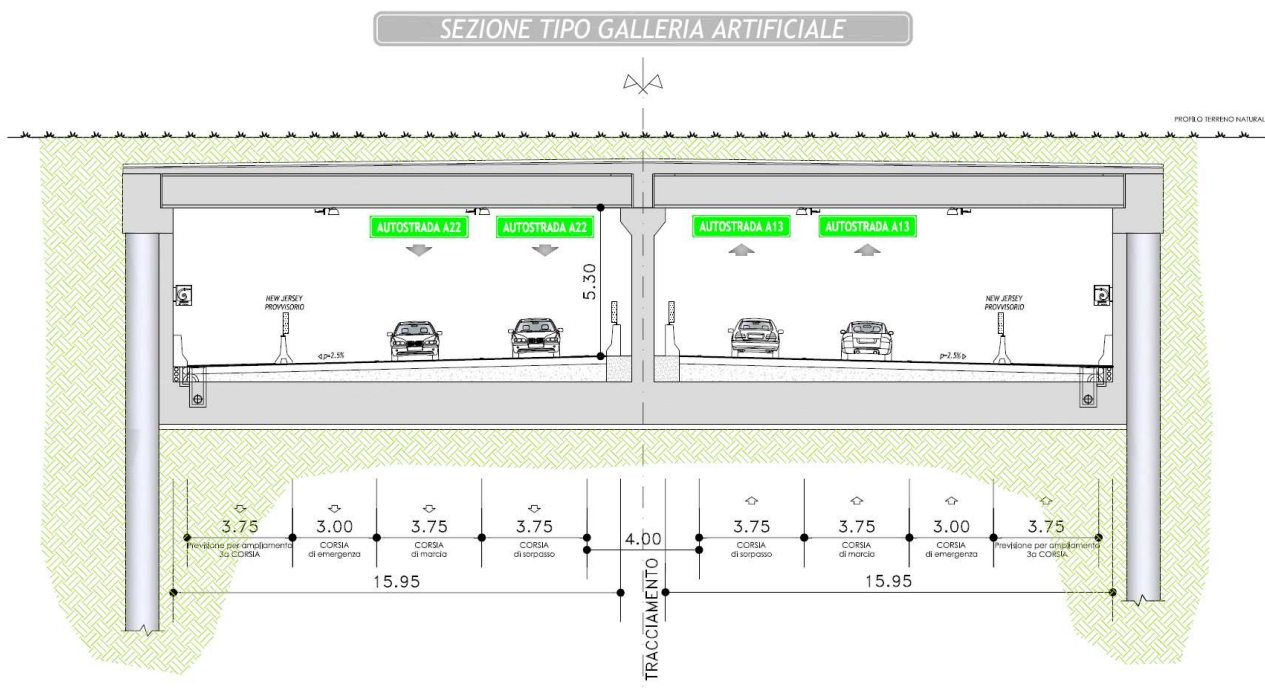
SEZIONE TIPO IN TRINCEA CONFINATA CON DIAFRAMMI
